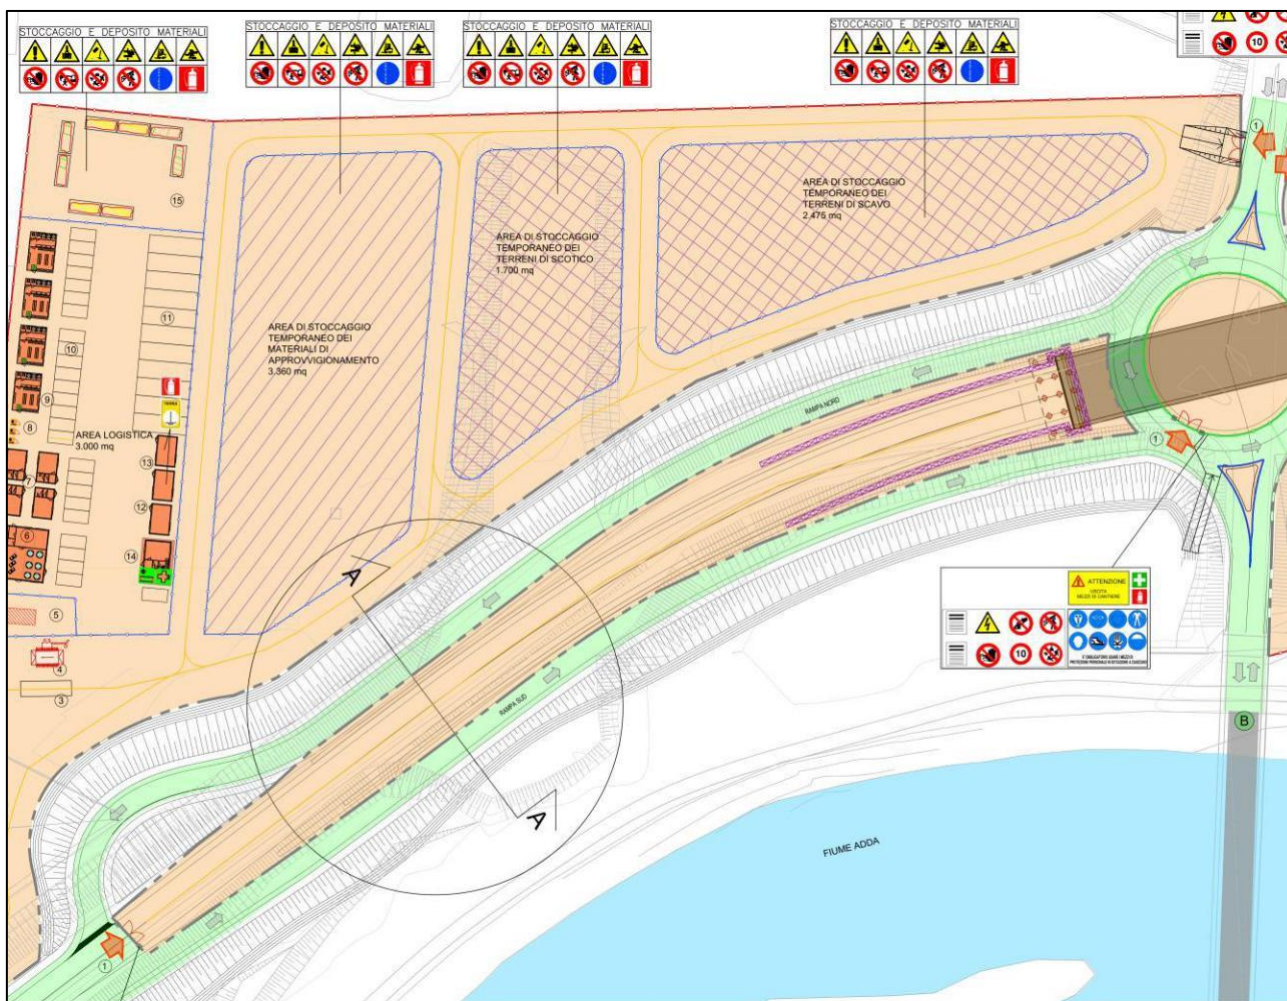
Realizzazione spalla A e muri di contenimento
